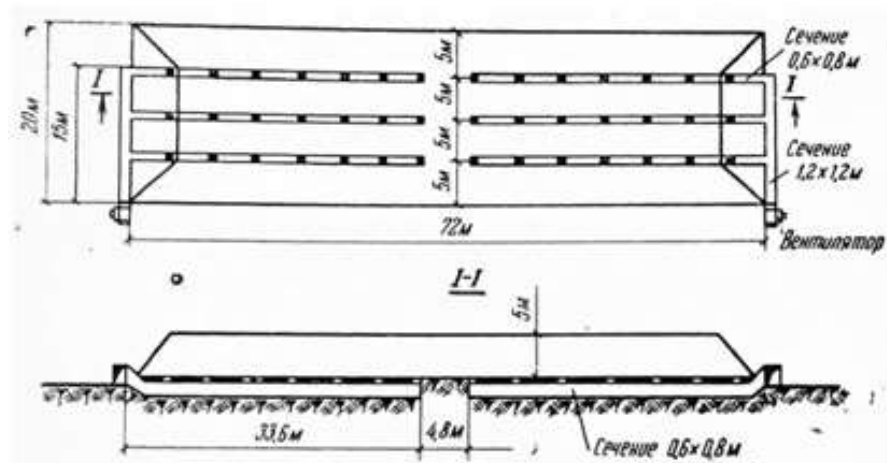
Продольная схема вентиляции расположения вентиляционных ветвей
